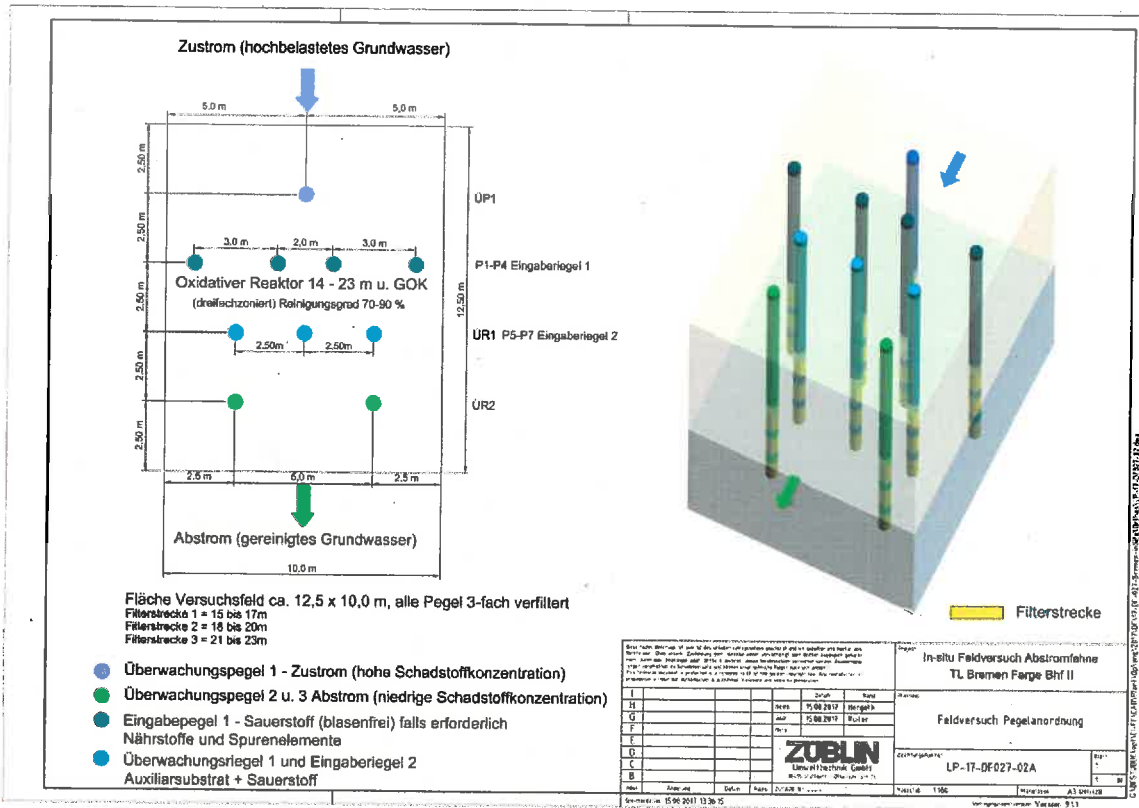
Lageplan der Injektions- und Monitoringpegel
